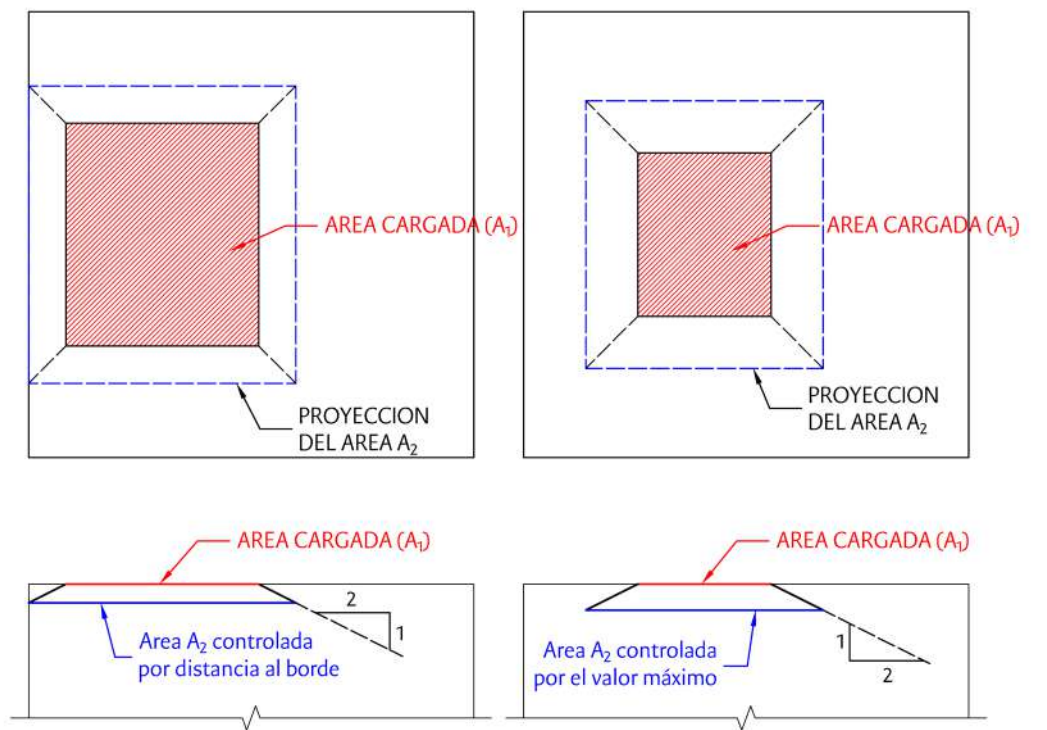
Área de aplastamiento. Referencia: 5.6.12.3.
